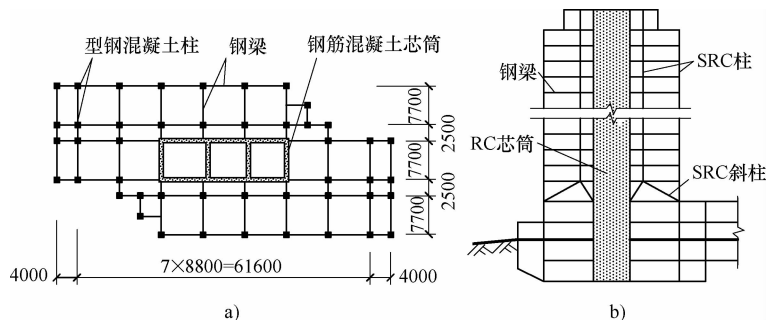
香格里拉饭店的混凝土芯筒-型钢混凝土框架体系
